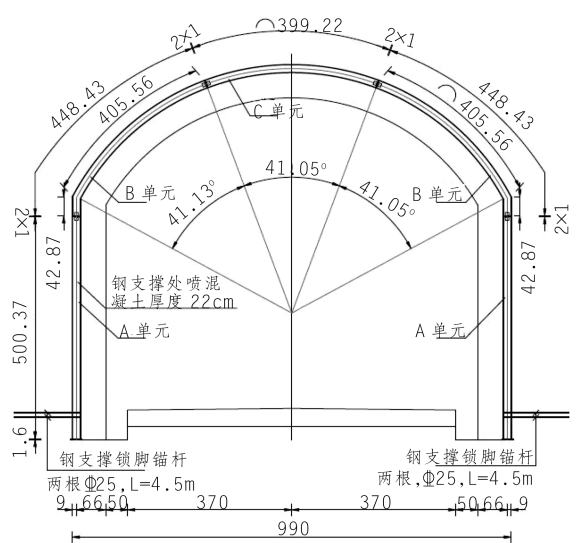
引水 2 号施工支洞过苏洼龙—王大龙断裂带段型钢拱架安装设计图(单位:cm)
